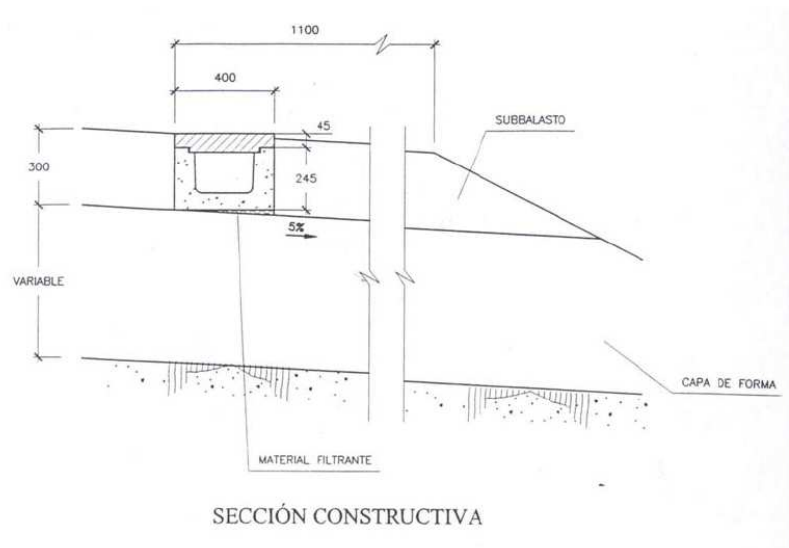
Detalle de la sección constructiva de la canaleta enterrada (Fuente:ADIF)
